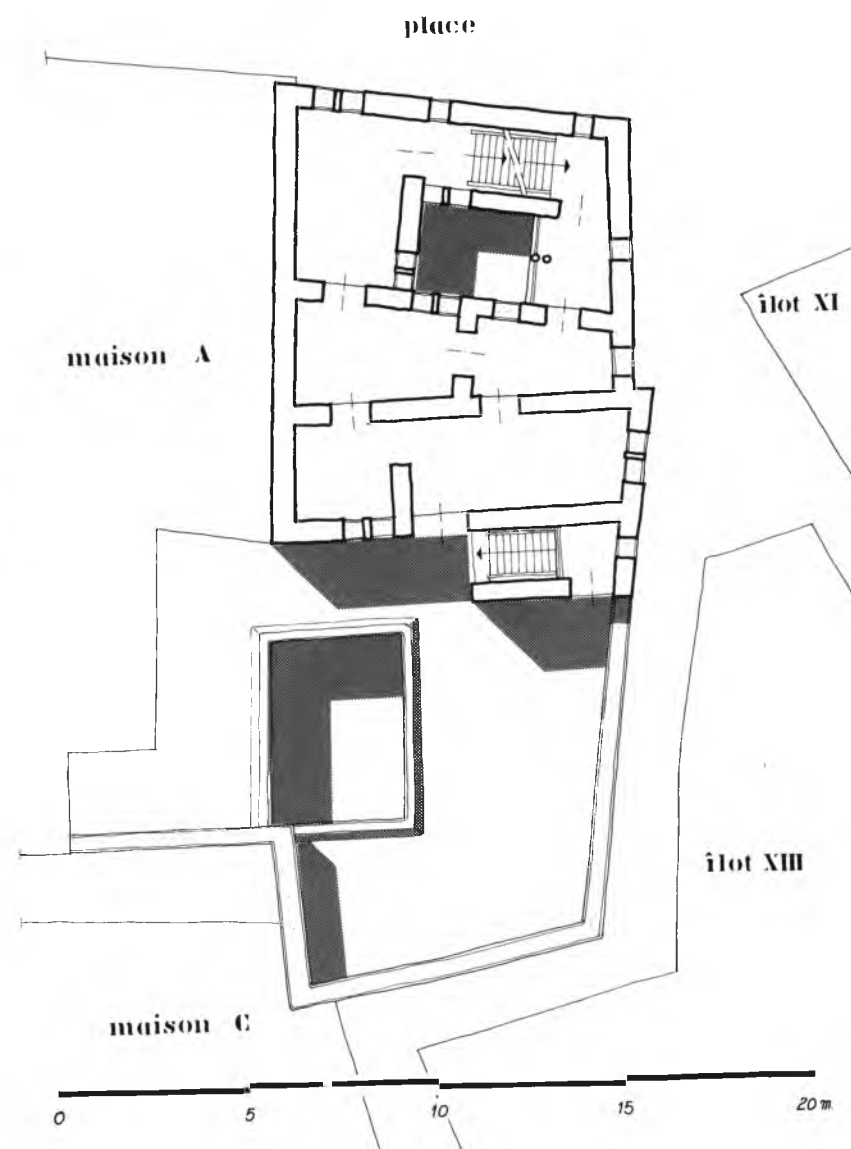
Îlot X : Maison B, plan restitué du second étage.
